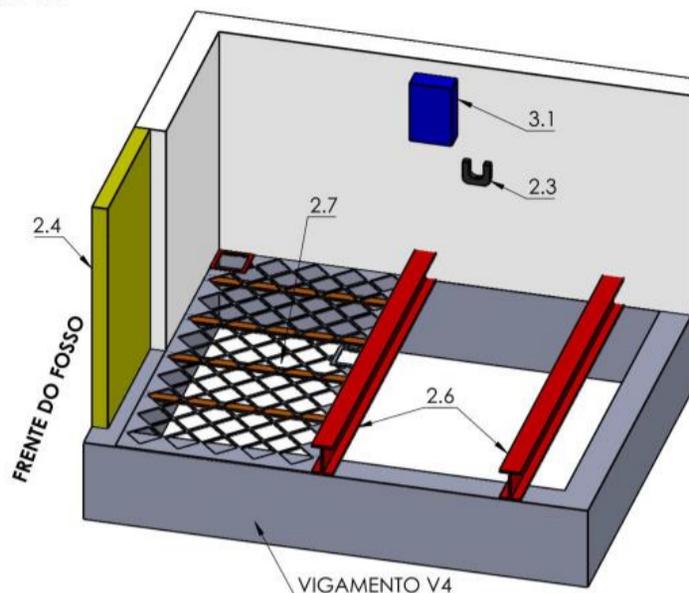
detalhe da plataforma Z e vigas metálicas Projeto Executivo - RAYS
